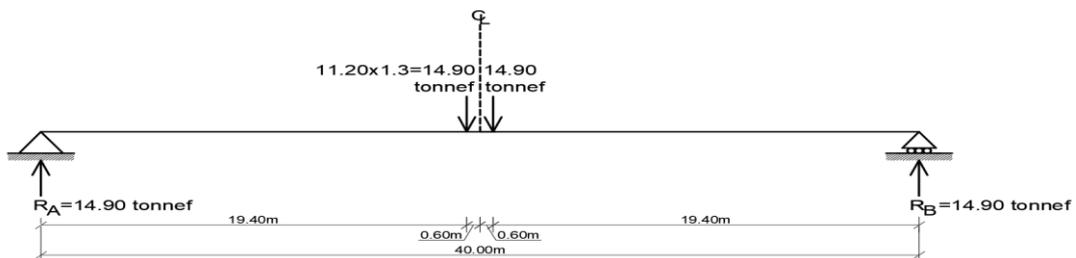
Carga viva de tándem aplicada sobre la viga metálica [Elaboración propia]
